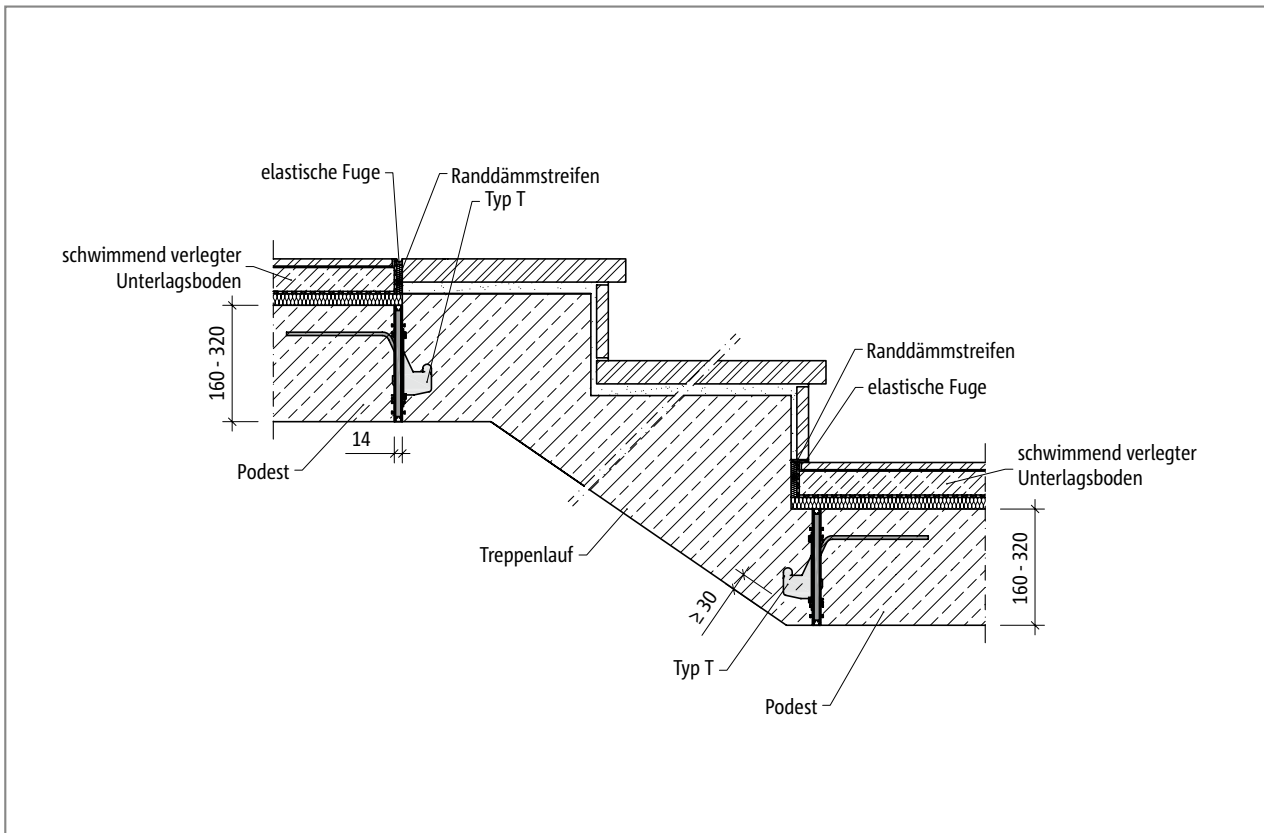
Schöck Tronsole® Typ T: Einbauschnitt
